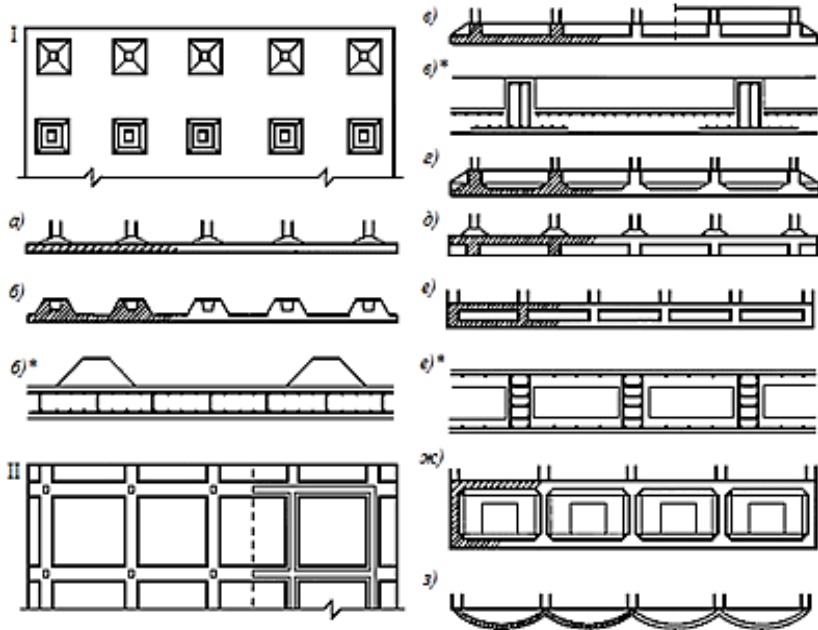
Суцільні фундаменти: I – плоскі плитні; а...б\* – конструкції плоских плит з підколонниками; II – ребристі плитні; в...д – конструкції ребрих плит; е...ж – конструкції коробчастих фундаментів; з – оболонкові фундаменти
